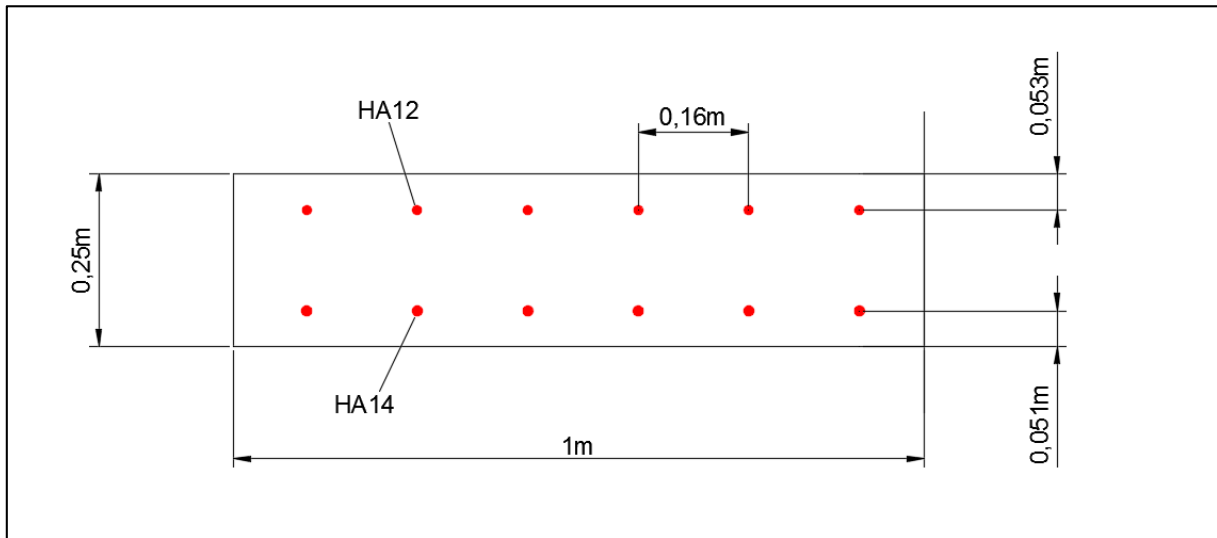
Ferrailage de l'hourdis dans le sens longitudinal
